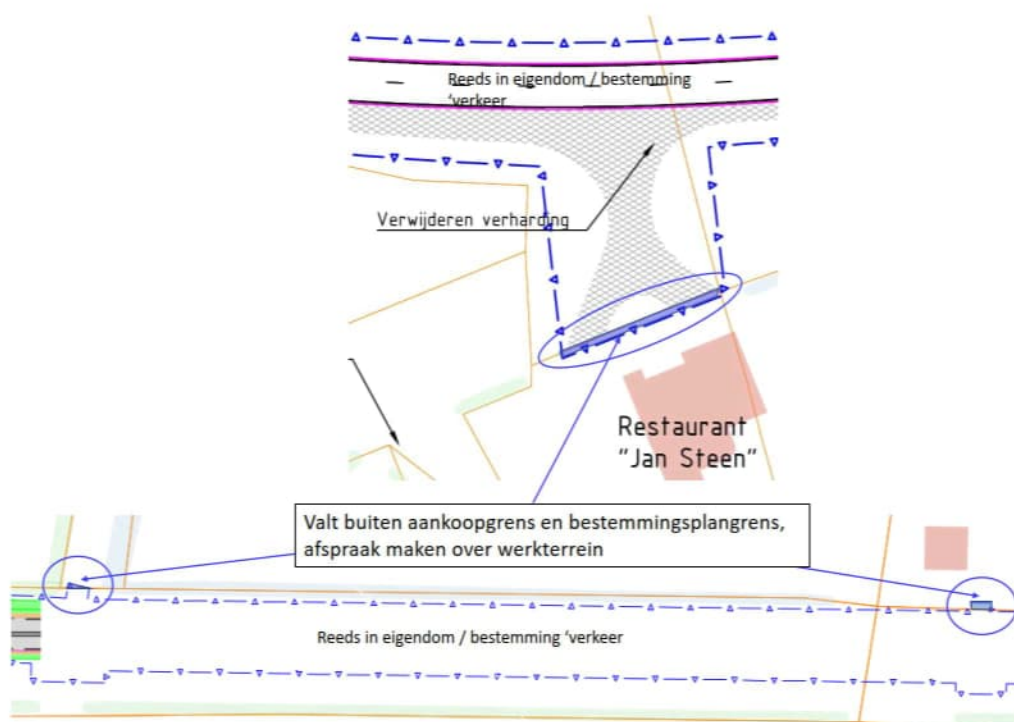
Verbeelding ontwerp met plangrens en aangepaste bestemmingsplan- en aankoopgrens
